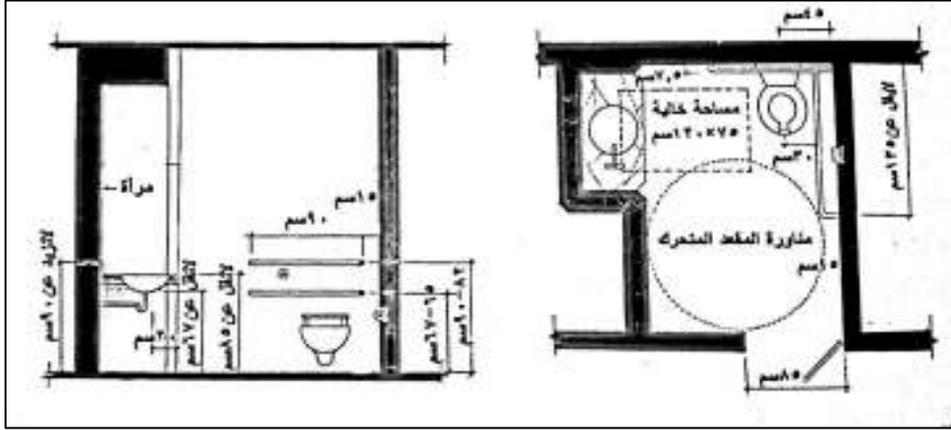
واجهه جانبيه ومسقط أفقي لمبوله
